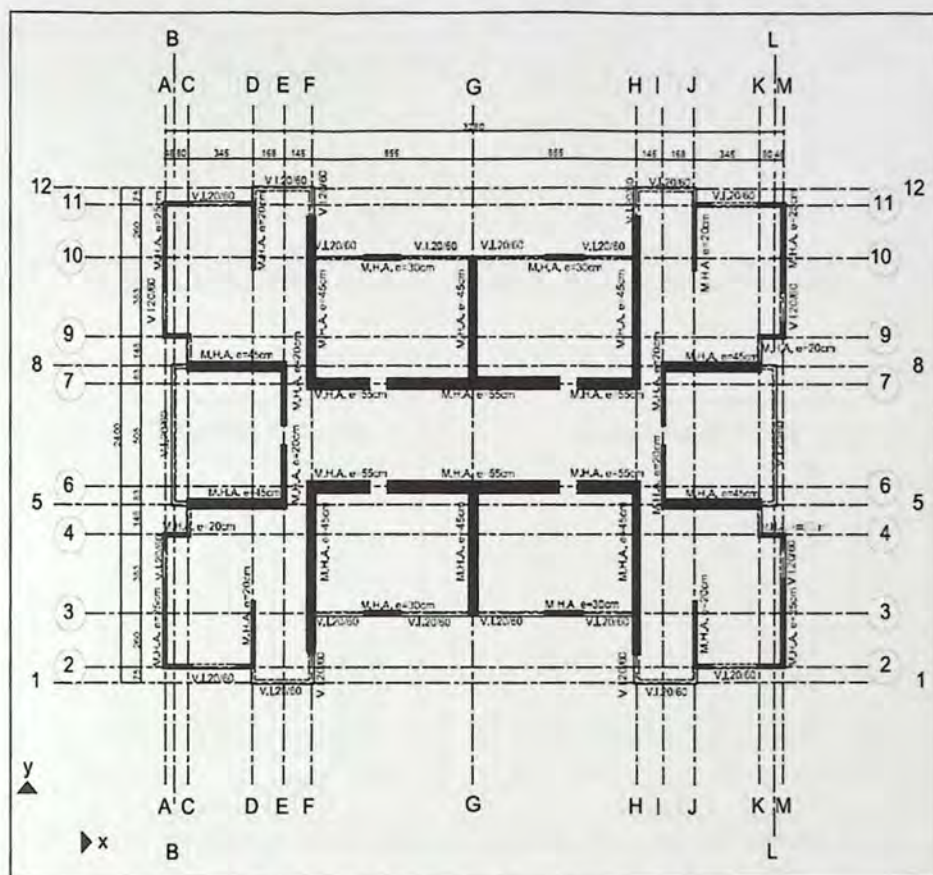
Planta de estructuras con nuevos espesores de muro.
